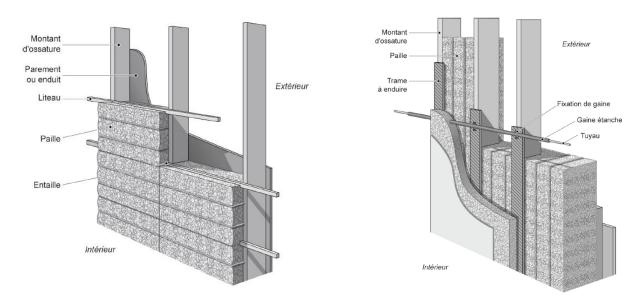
Pose horizontale sur chant Fig 7 : Pose verticale sur chant Source : Règles Professionnelles de la Construction Paille
